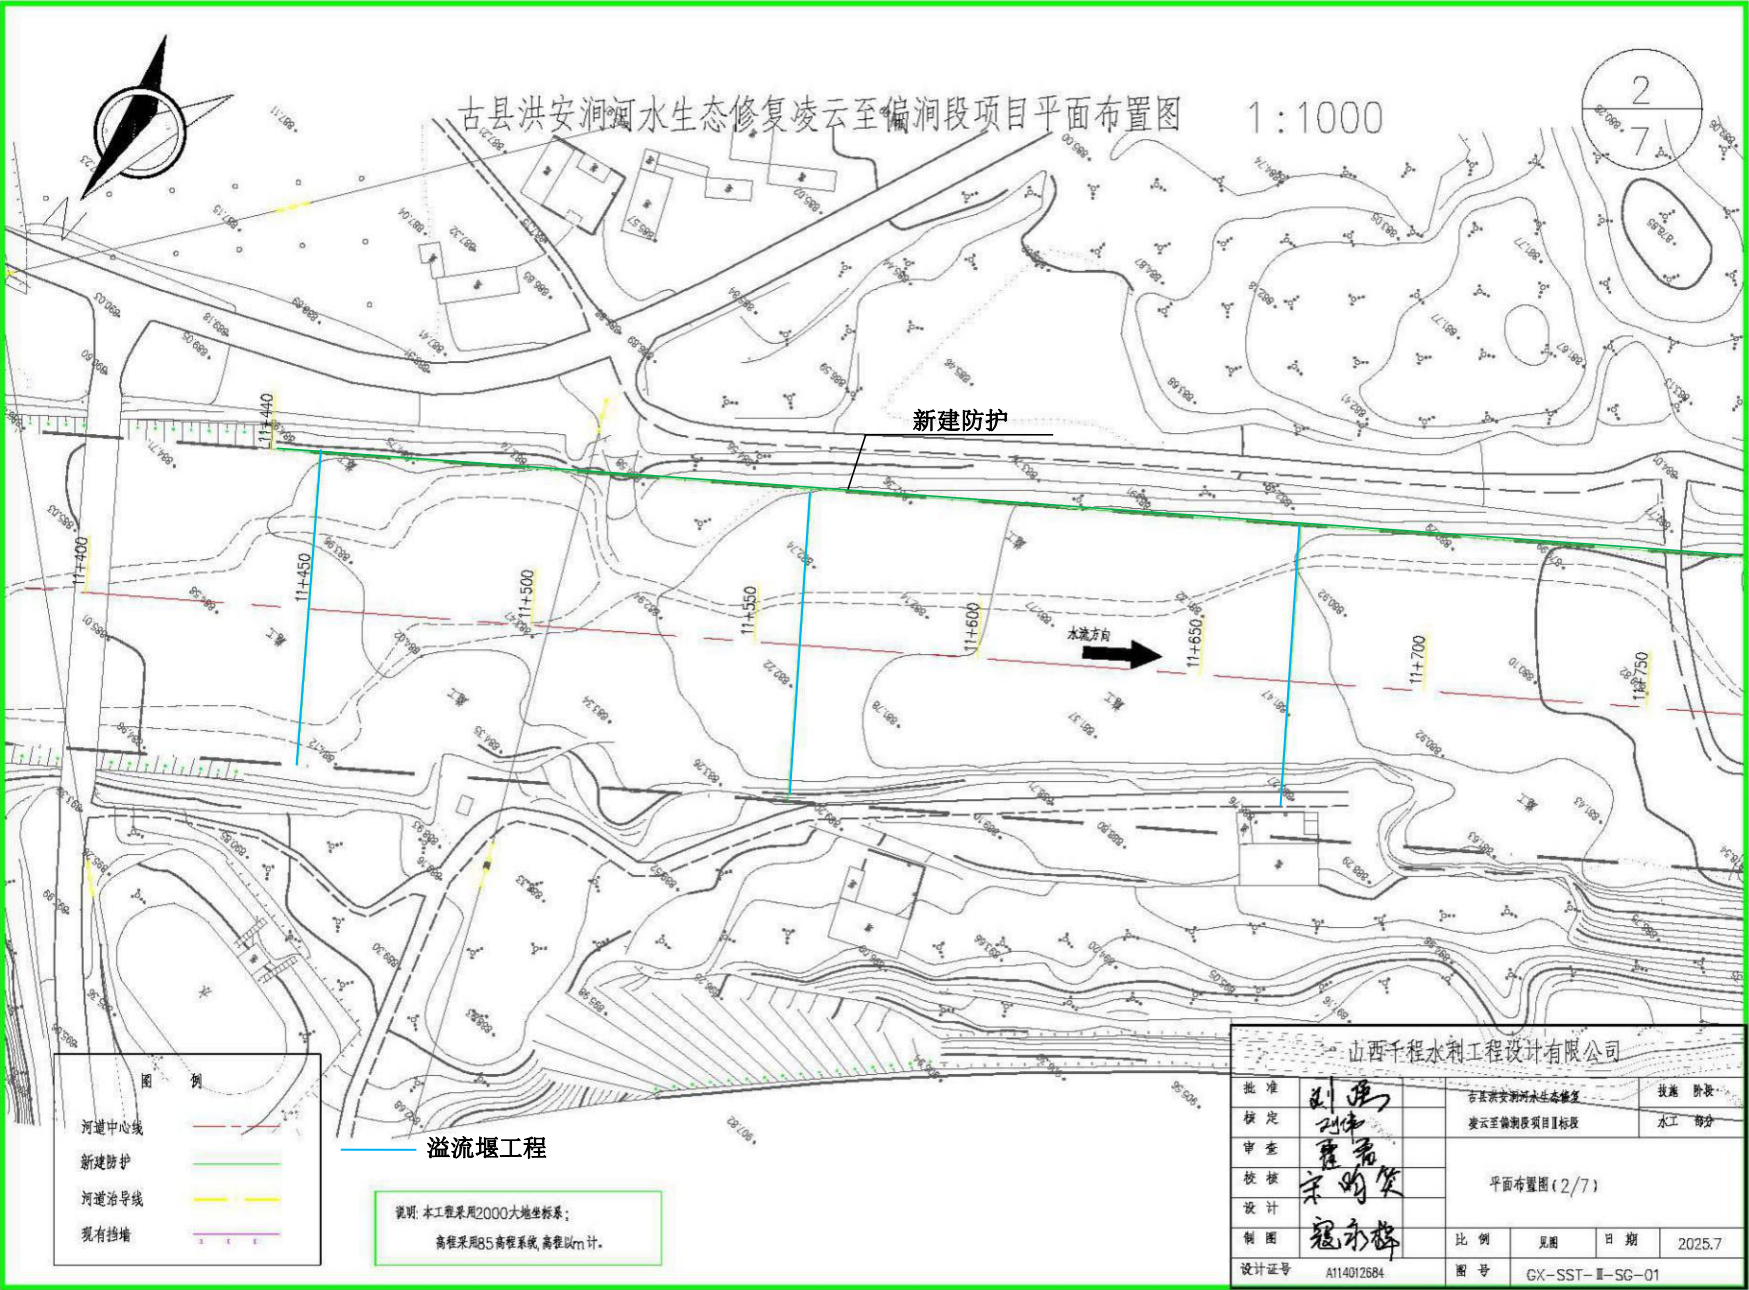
(6) 工程总平面布置图 (桩号 11+400-11+750)
